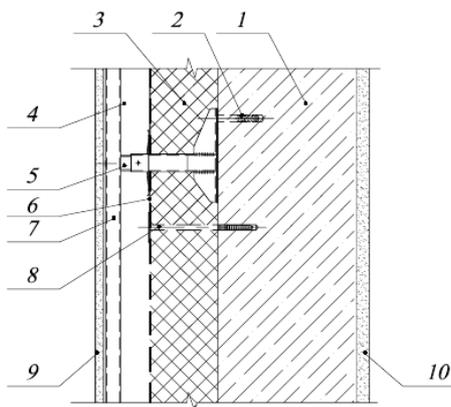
Система утепления фасадов с отделочным слоем из штукатурки
